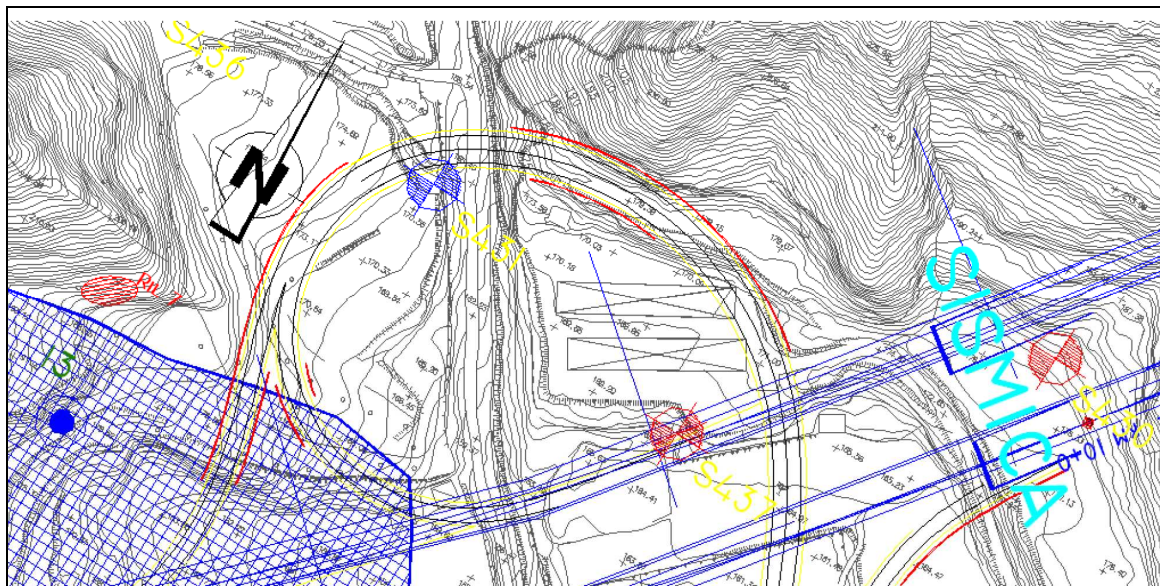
Ubicazione in planimetria dell'affioramento oggetto del rilievo geostutturale
